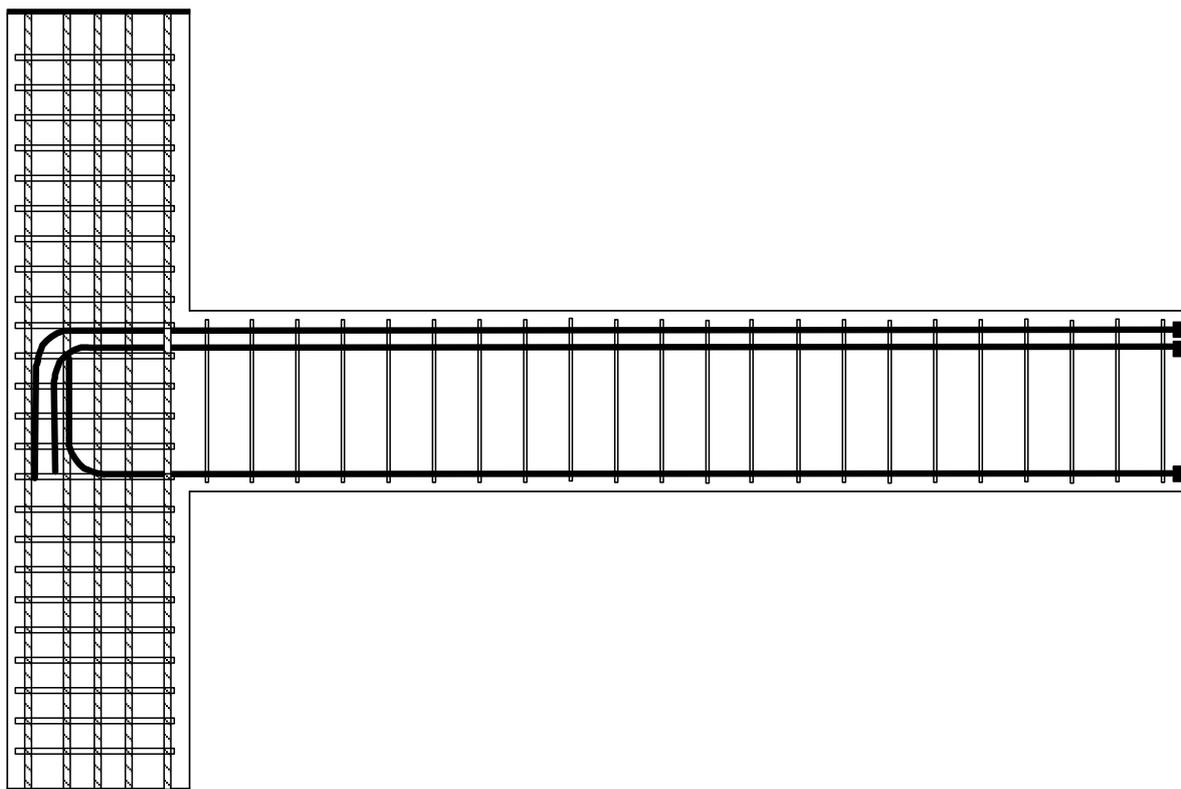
RC 梁試體組模及混凝土澆置方向示意圖
